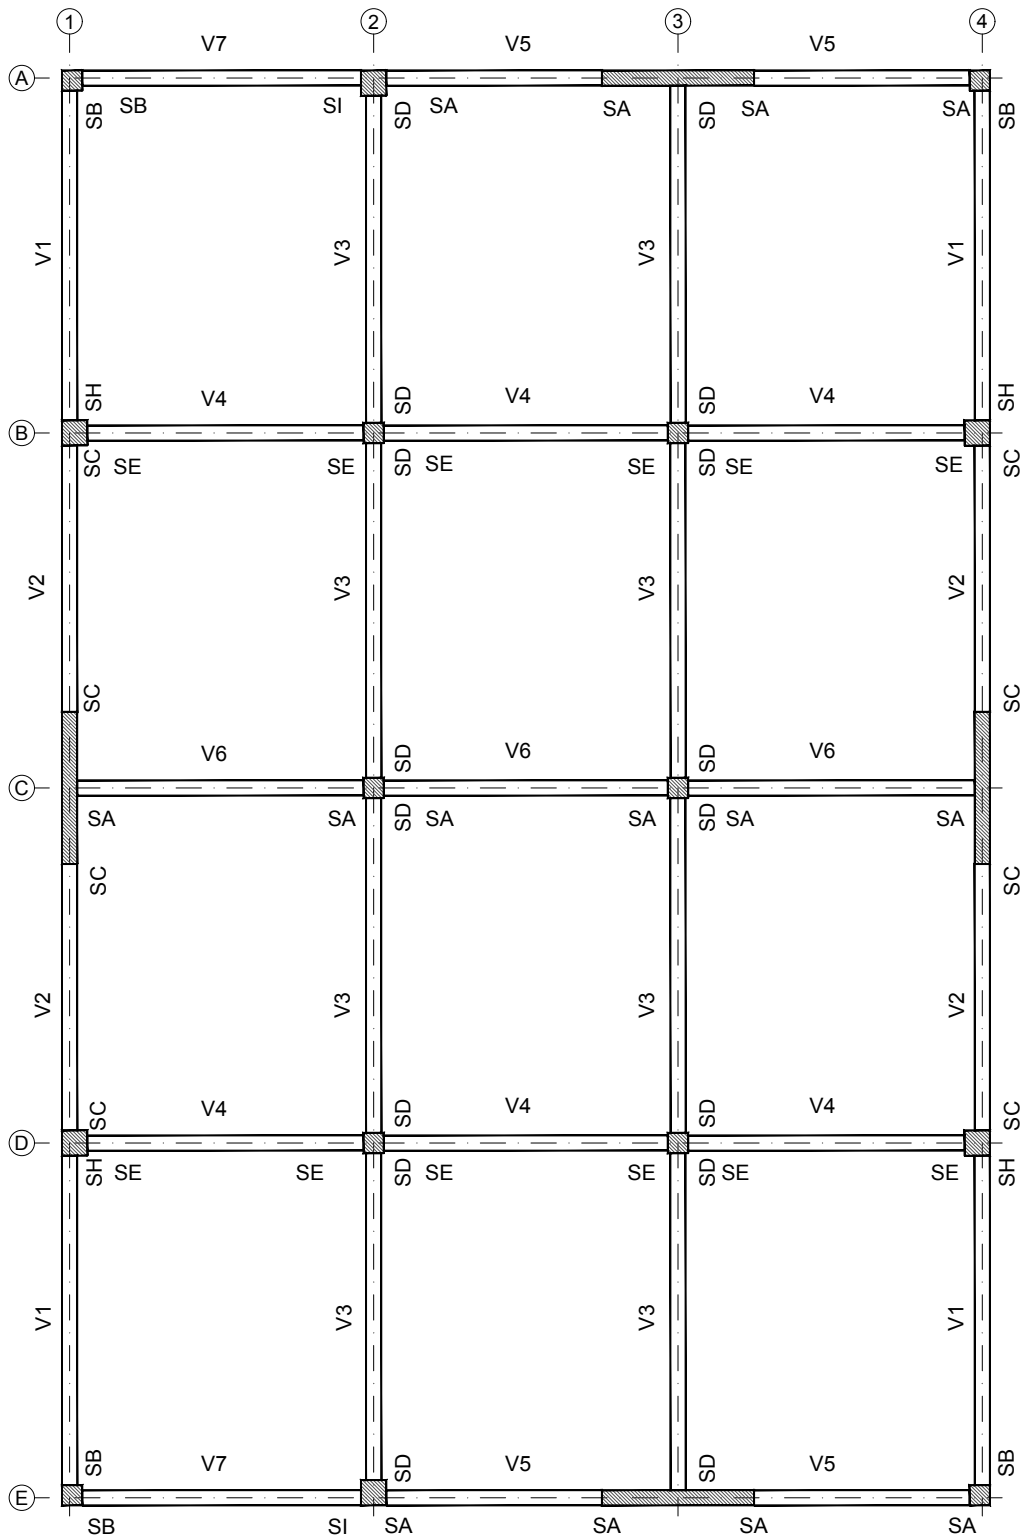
Vigas e secções de armadura das vigas – Piso 9.
